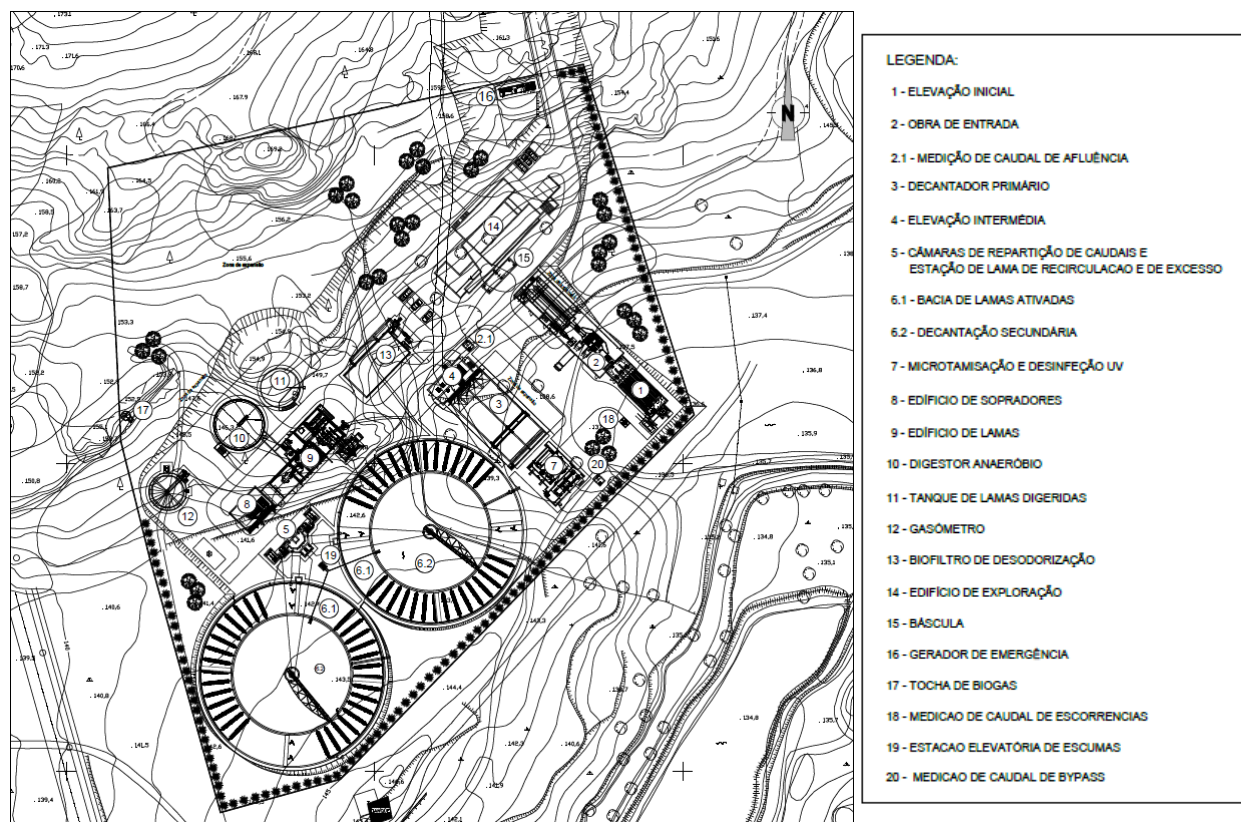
Planta de implantação da ETAR (Fonte: EIA – agosto de 2016).
